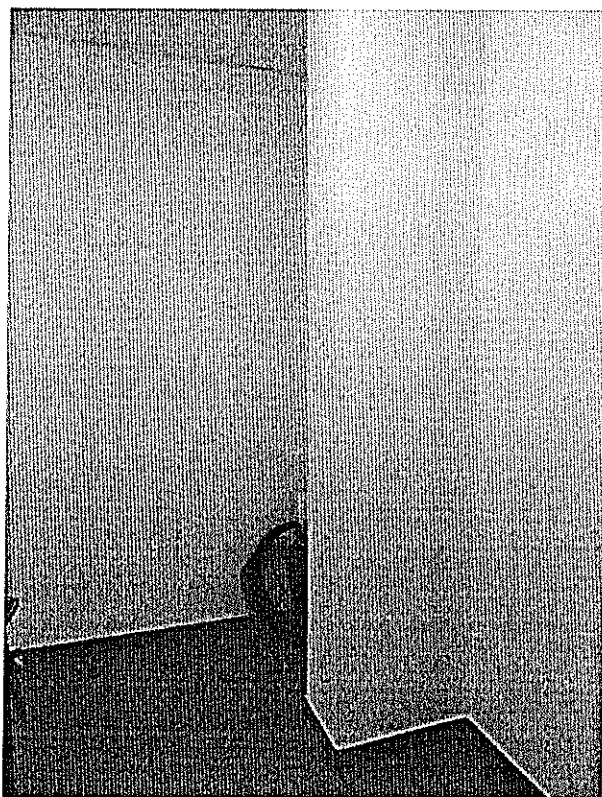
Locale deposito del primo corpo di fabbrica – piano terra.
